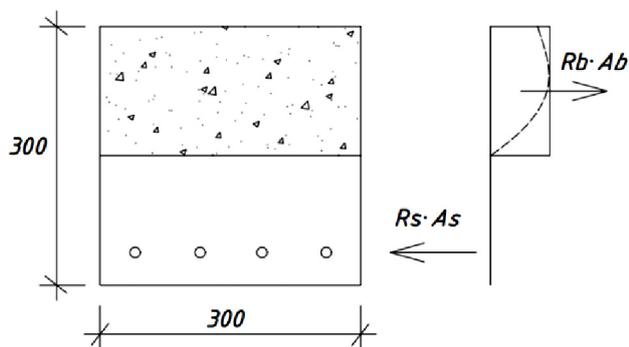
Нормальное сечение и эпюры напряжений перемычки с арматурой
